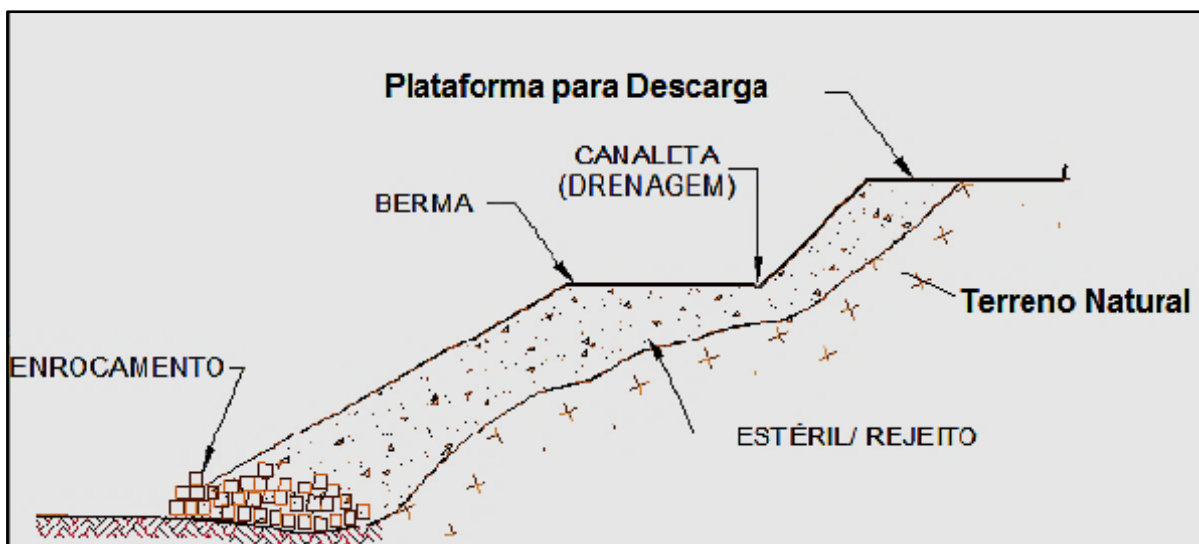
Perfil esquemático da Pilha de Estéril/Rejeito.
